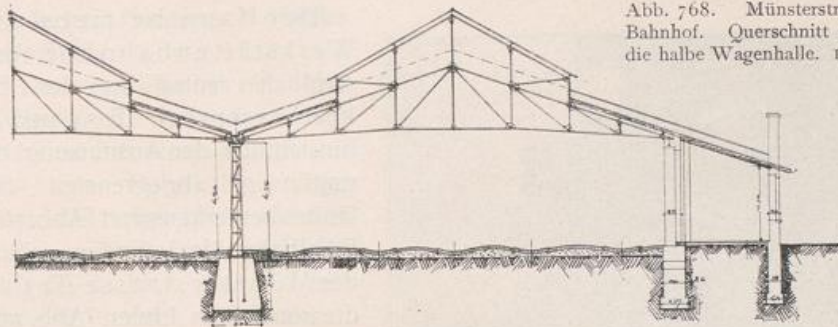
Münsterstrassen-Bahnhof. Querschnitt durch die halbe Wagenhalle. 1:300.
